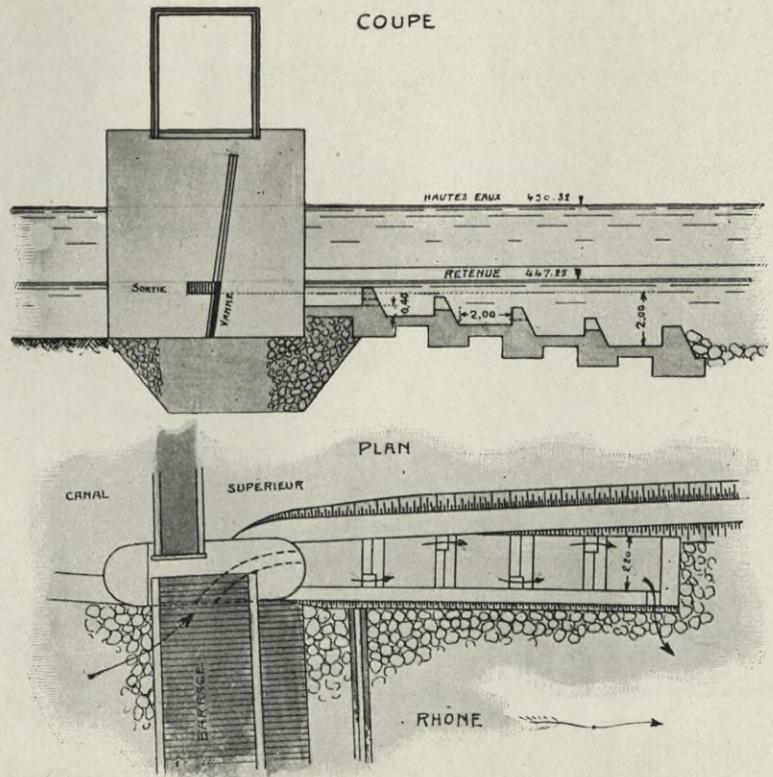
Barrage de l'usine de St-Maurice. Plan et coupe de l'échelle à poissons. Maßstab 1 : 300.
